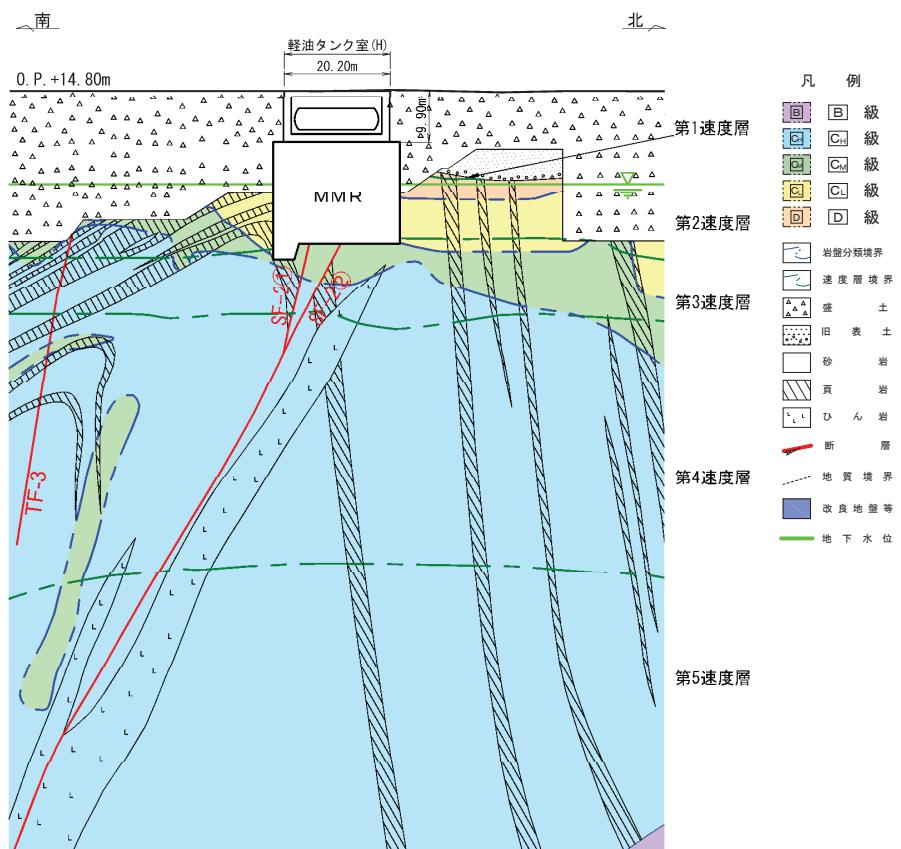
軽油タンク室 (H) 地質断面図 (B-B)
